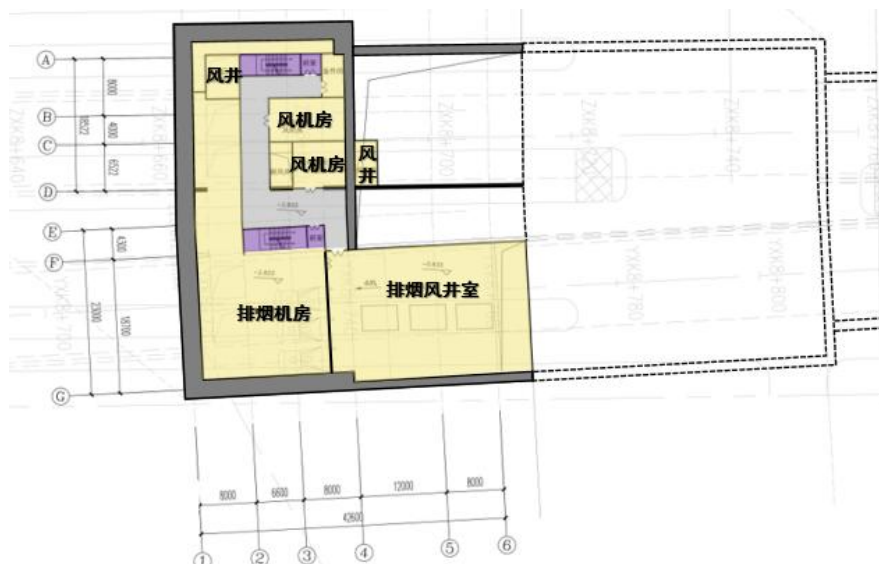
南岸设备用房地下 1 层夹层平面图
